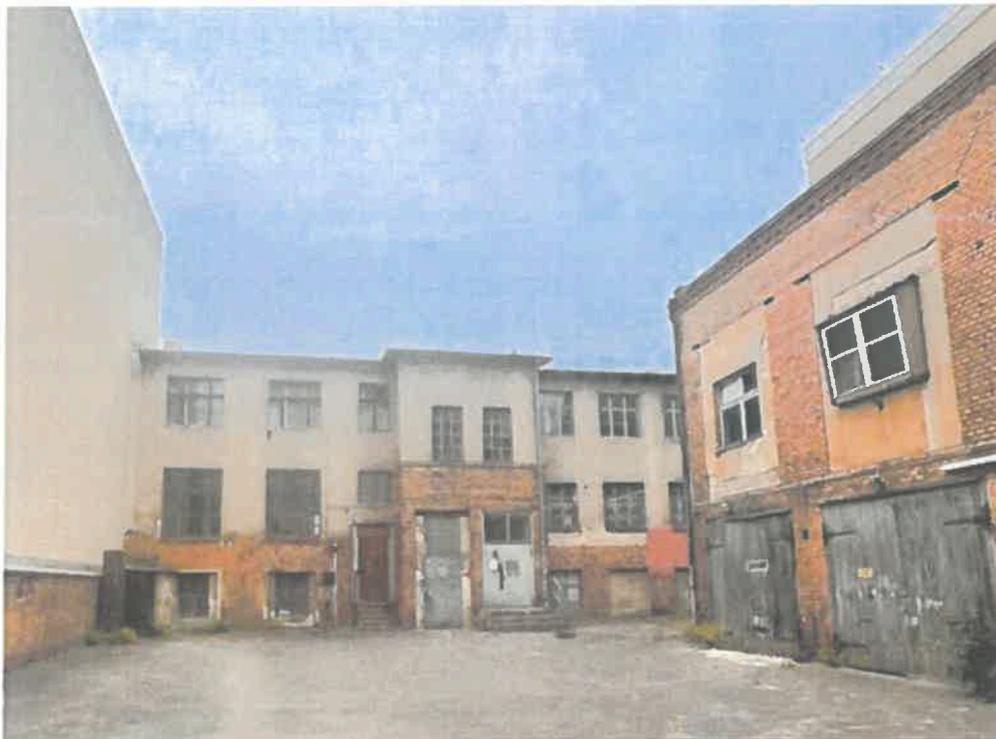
Rückwärtige Ansicht des Vorderhauses mit Blickrichtung Südwesten. Rechts im Bild: Werkstattgebäude mit beschädigter Klinkerfassade oberhalb der Fenster. Standort: Innenhof.
